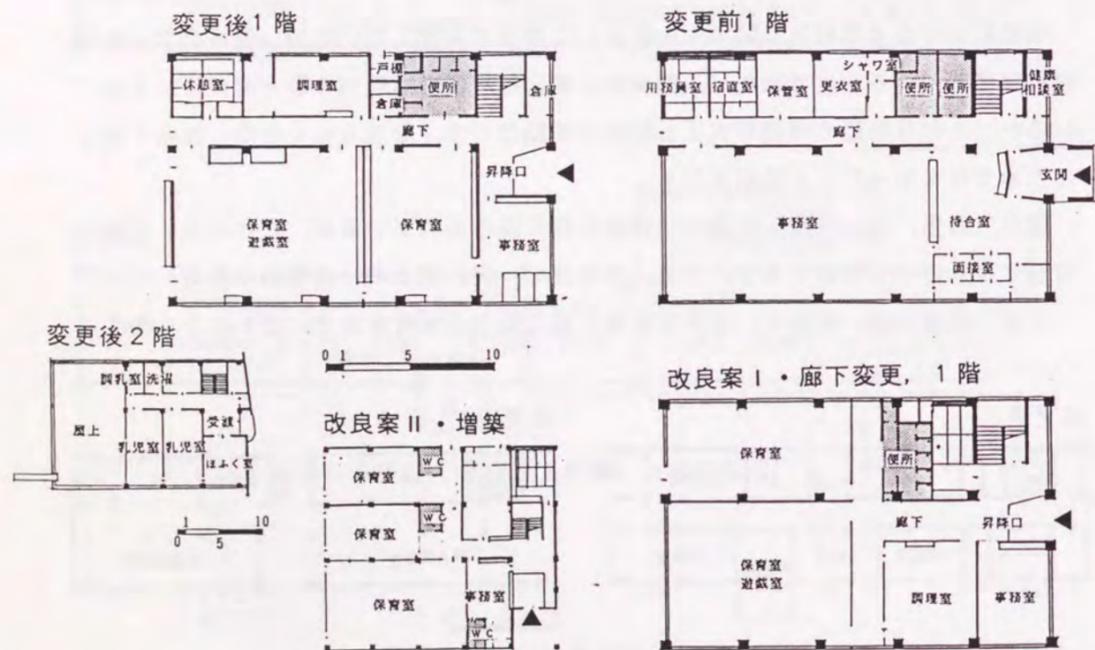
<28>練馬区石神井保育所(旧福祉事務所)平面図
